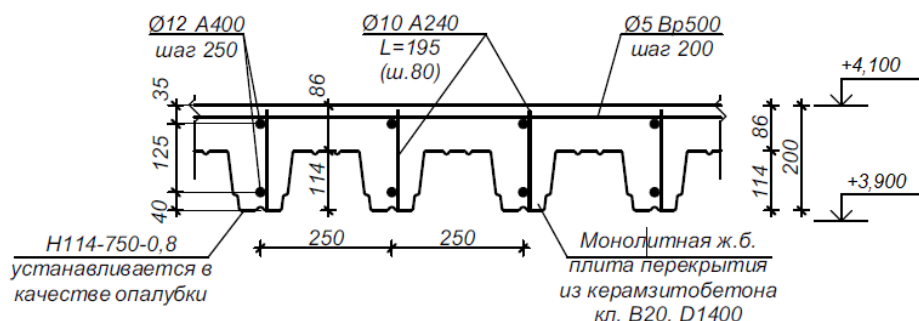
Схема расположения ж/б плиты перекрытия
